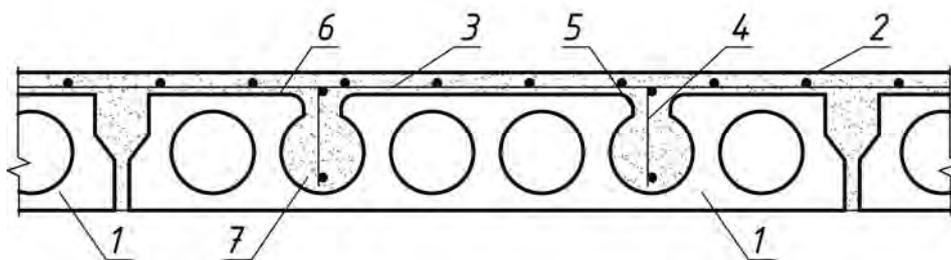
Обетонирование плит сверху при усилении зоны сжатия: 1 – усиливаемая плита; 2 – монолитный бетон; 3 – сетка арматурная; 4 – арматурные каркасы; 5 – вырубленная часть плиты для установки каркасов; 6 – поверхность контакта монолитного бетона с плитами; 7 – бетон замоноличивания вырубленной части плиты
